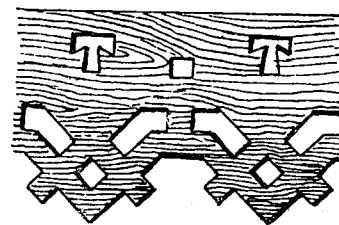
Lambrequín de madera recortada y calada; dibujo defectuoso para el material.
